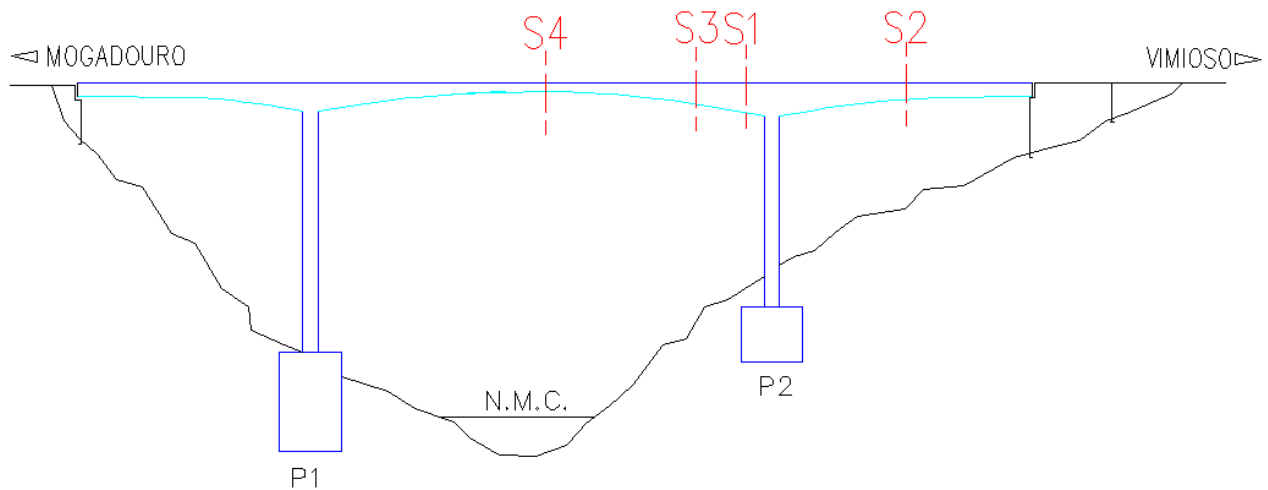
Ponte sobre o rio Angueira. Localização das secções instrumentadas
